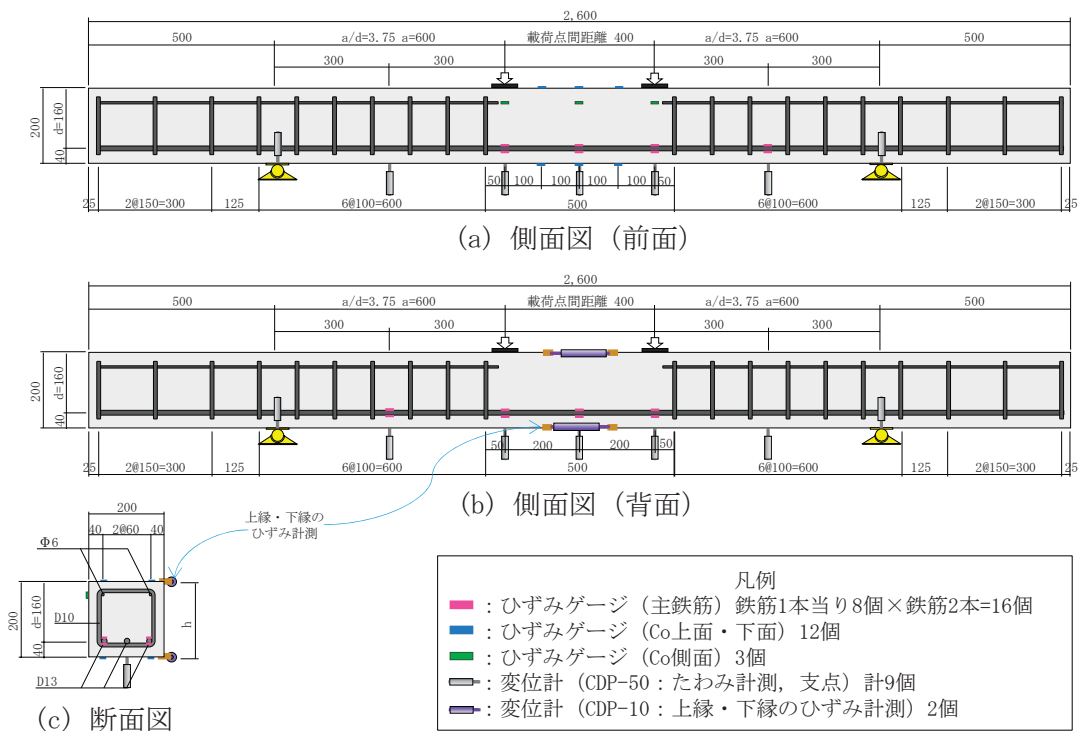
配筋および荷重位置, 支点位置, 計測機器設置状況 (ケース 1, 3)
